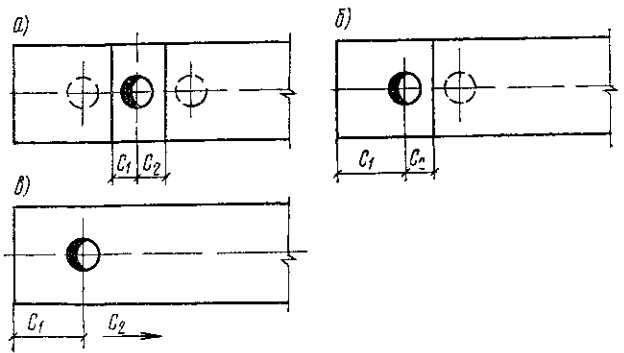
25 Расчетные схемы нагревательного элемента в перекрытии для определения границ поверхности теплоотдачи
